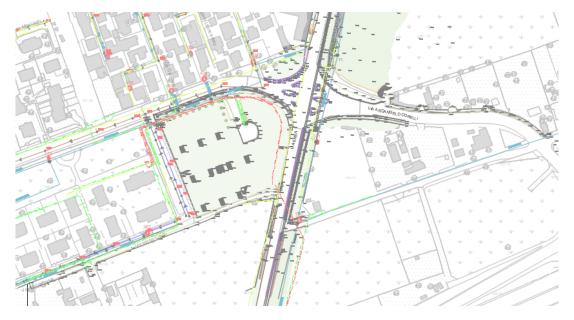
Stralcio planimetrico del rilievo area vasche di laminazione
